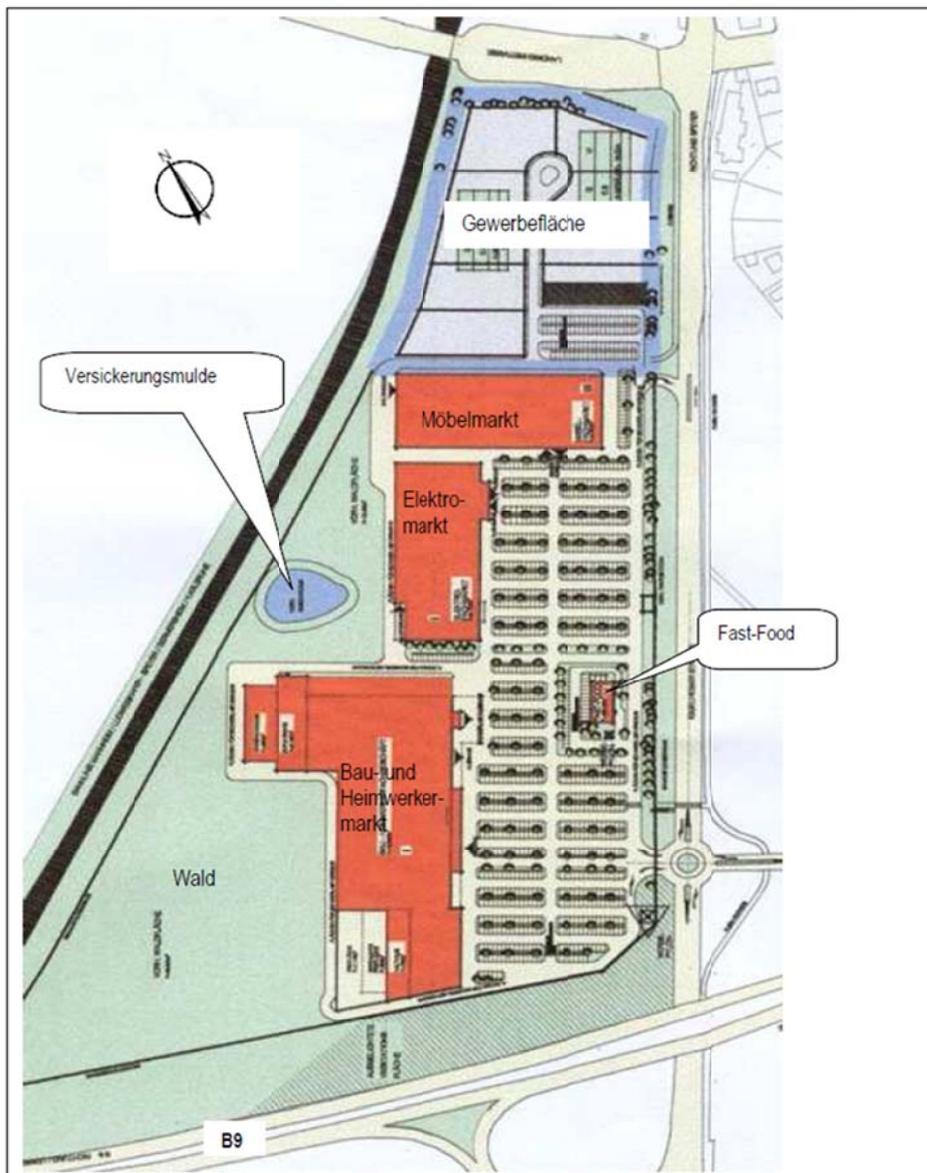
Lageplan der Fa. Heberger, 2002, ohne Maßstab
